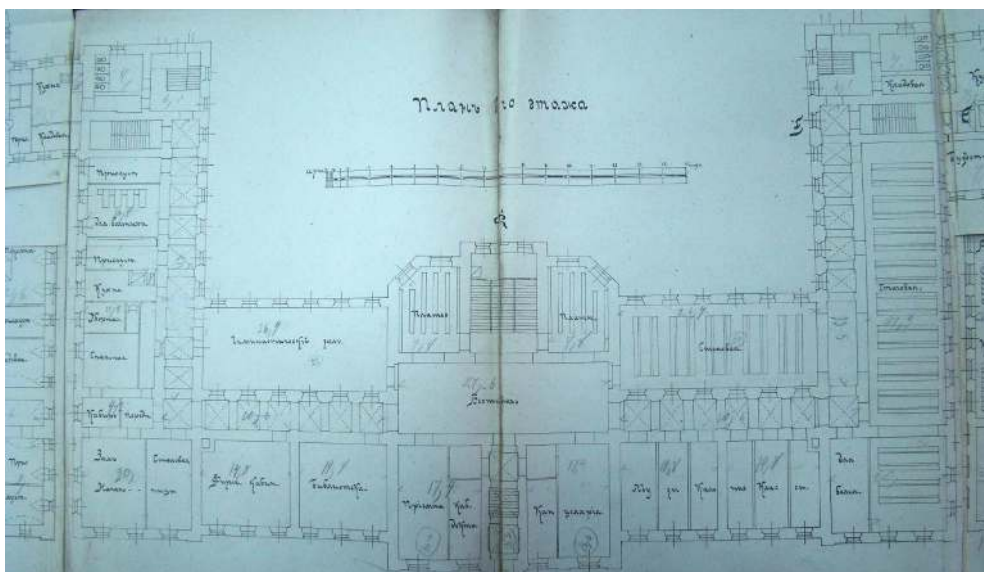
Епархиальное женское училище. План 1 этажа. (ГАКО, г. Киров) [5]
